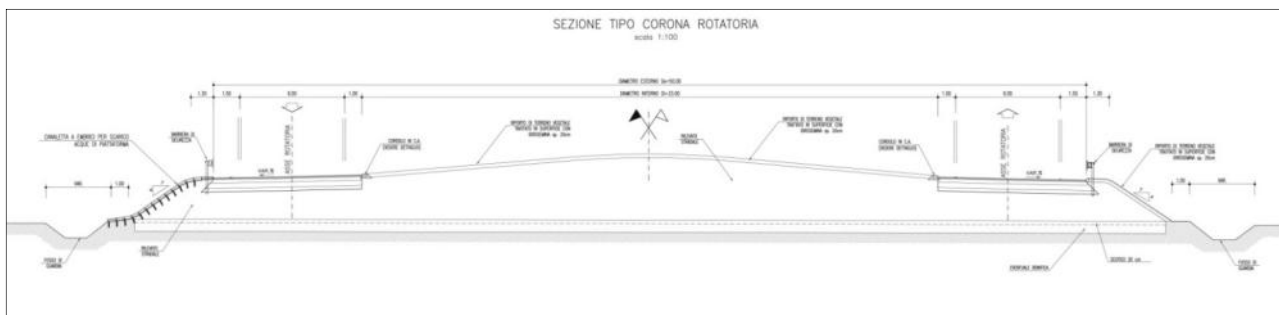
Sezione tipo – Sezione tipo – Rotatoria su S.P. Castelli.
